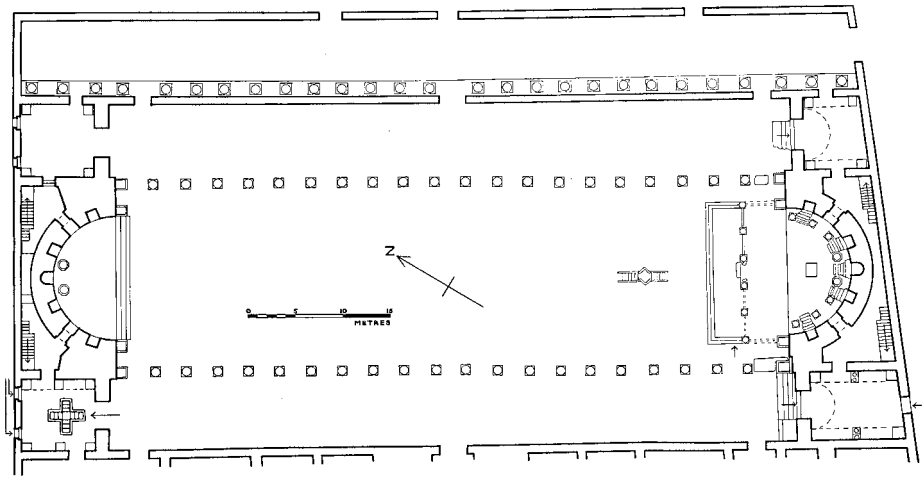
Grundriss der Kirche 1 (nach Goodchild – Ward Perkins 1953a, 23 Abb. 8)
